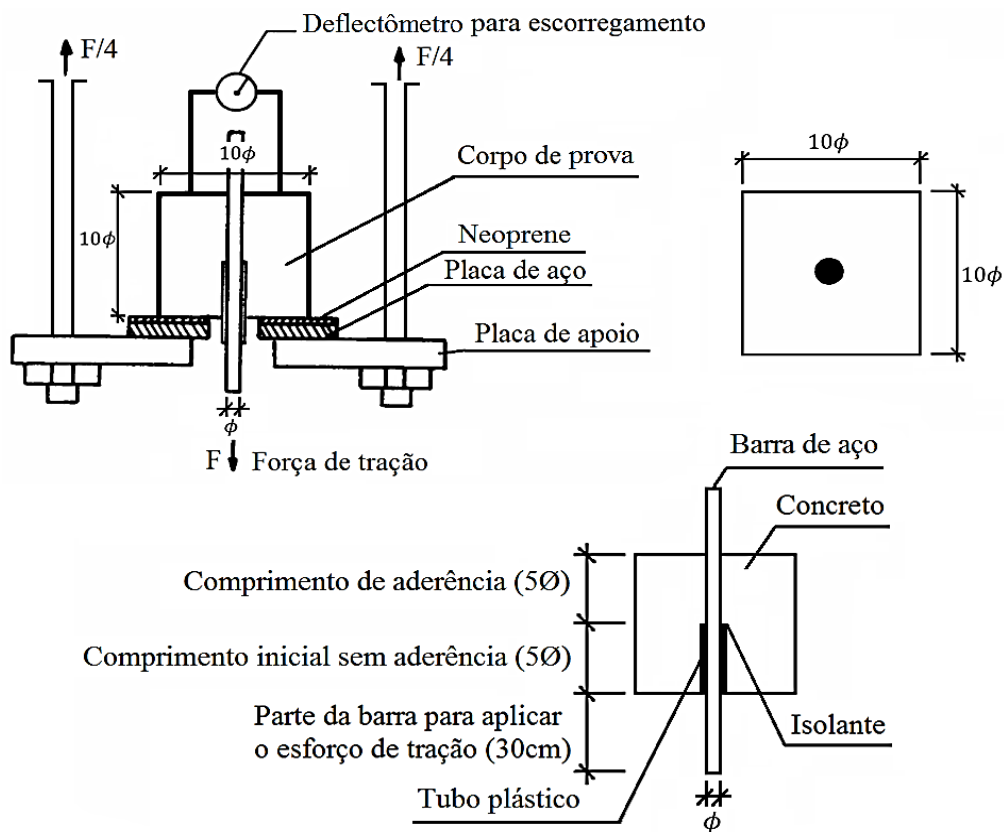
Representação esquemática dos corpos de prova propostos por RILEM RC5 (1973) - Modificado de França (2004).
